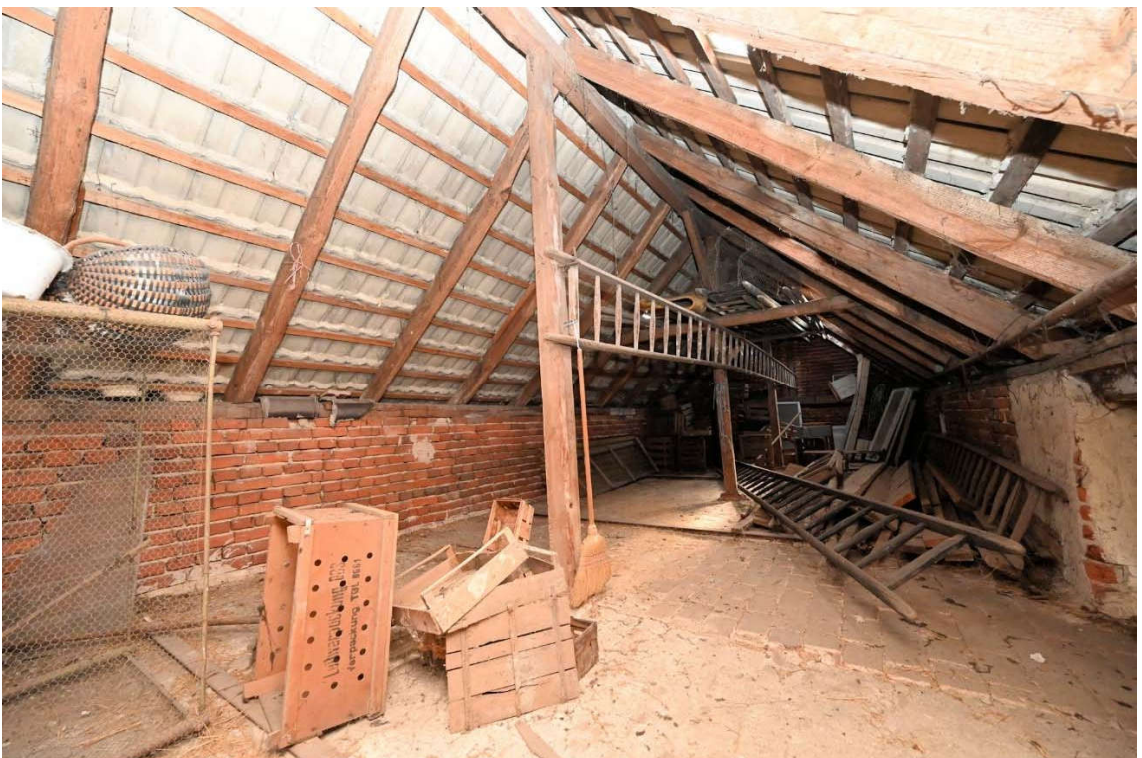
Nebengebäude B, Dachgeschoss, ehem. Heuboden
